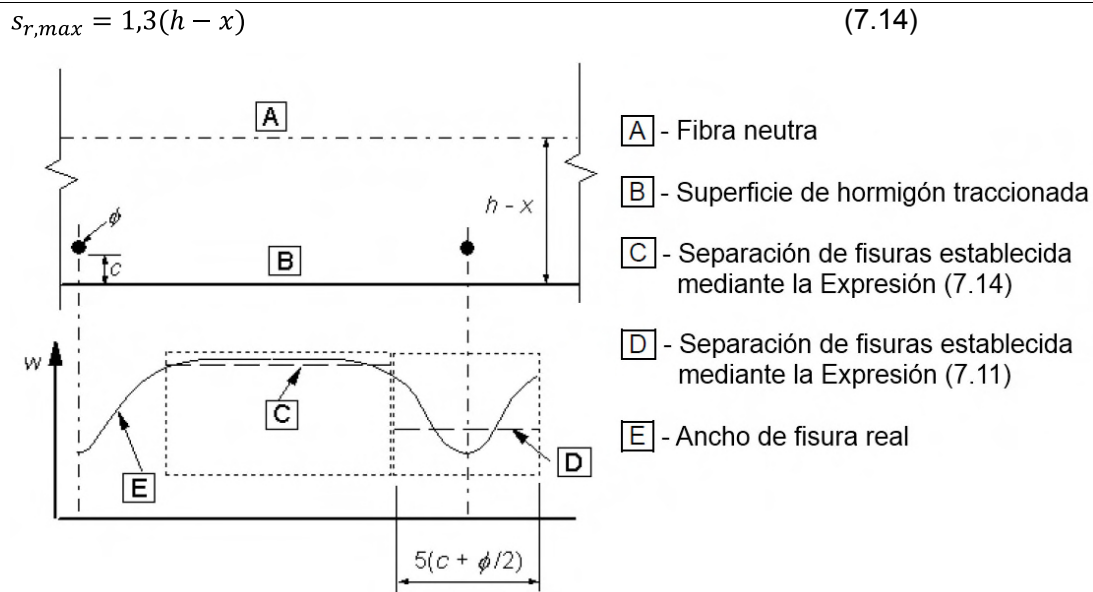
Abertura de fisura,  $w$ , en la superficie del hormigón, en función de la distancia a las armaduras
